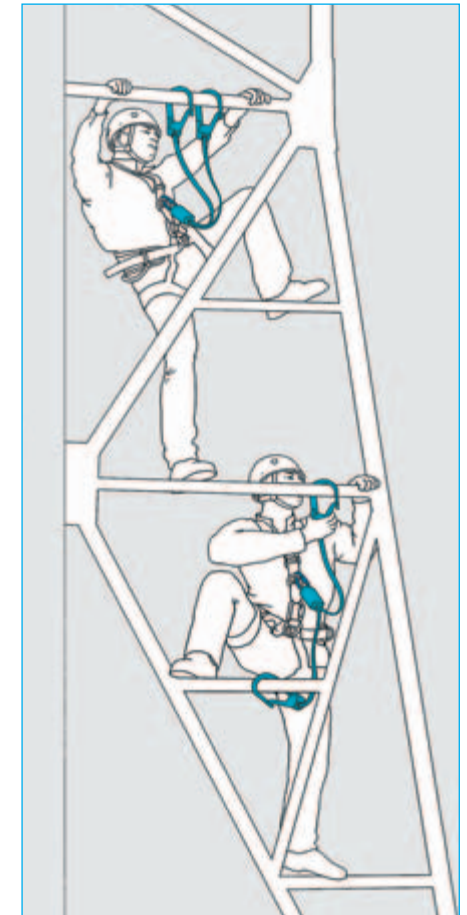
Anschlagvorrichtung als horizontale Führung
